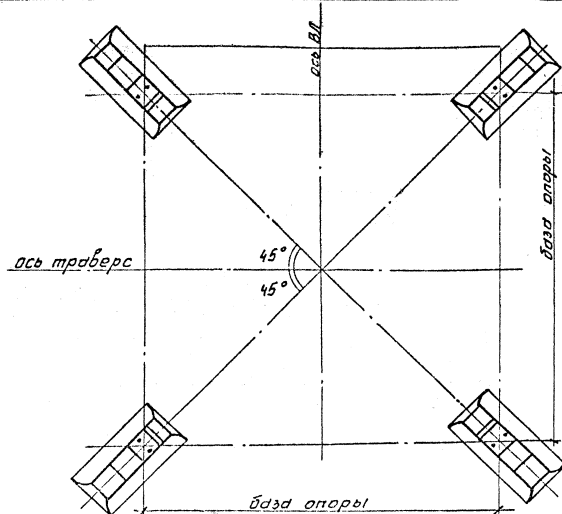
Схема установки унифицированных фундаментов под одну опору
